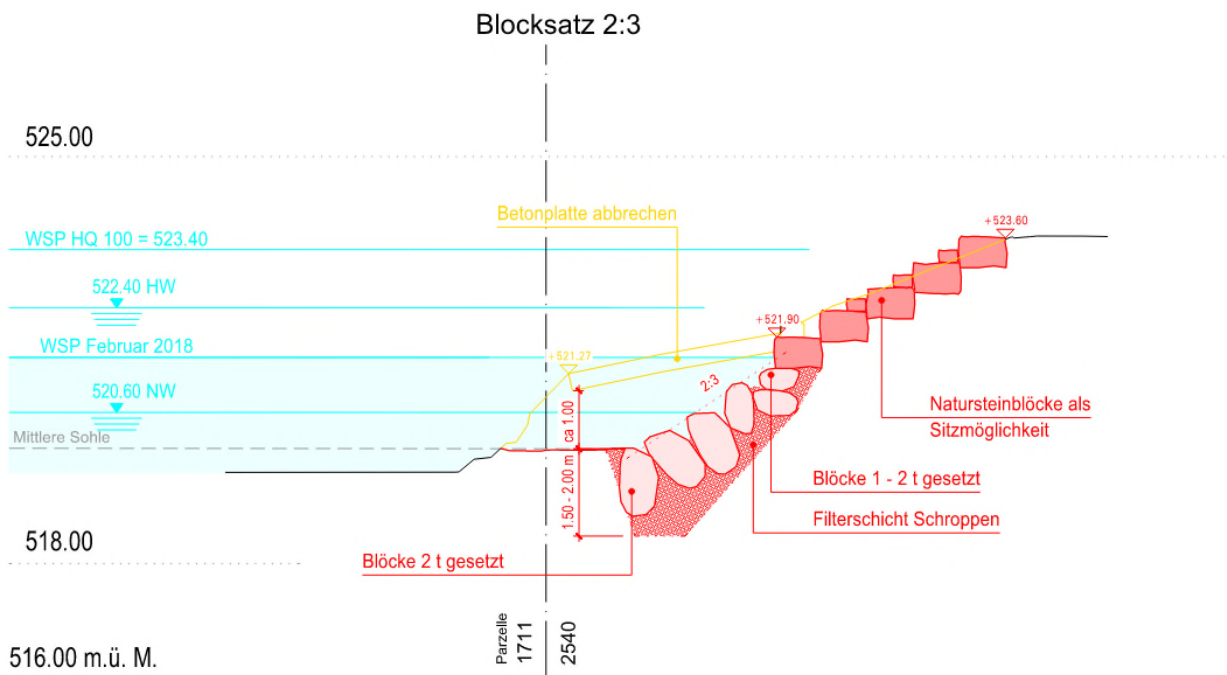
, Ausschnitt aus Querprofilplan (Beilage 3.3)
